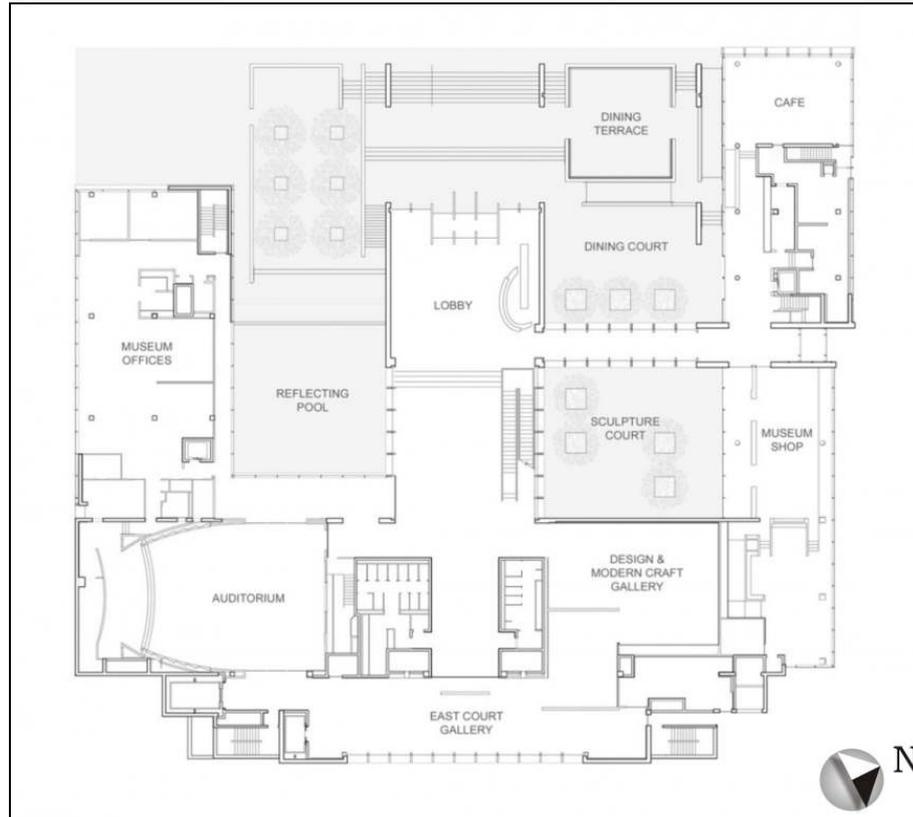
Planta baixa de térreo (BASULTO, 2009).
